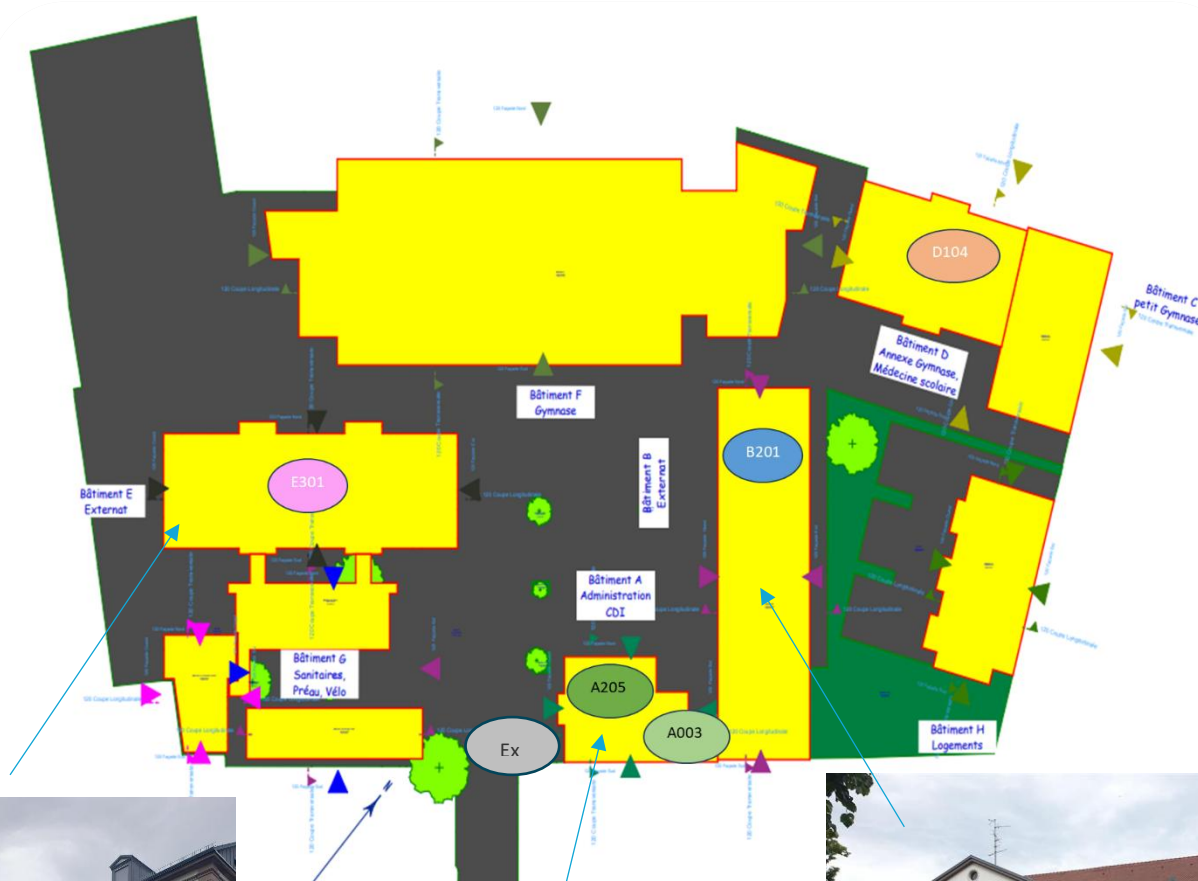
Plan du collège Kennedy à Mulhouse et salles instrumentées.
